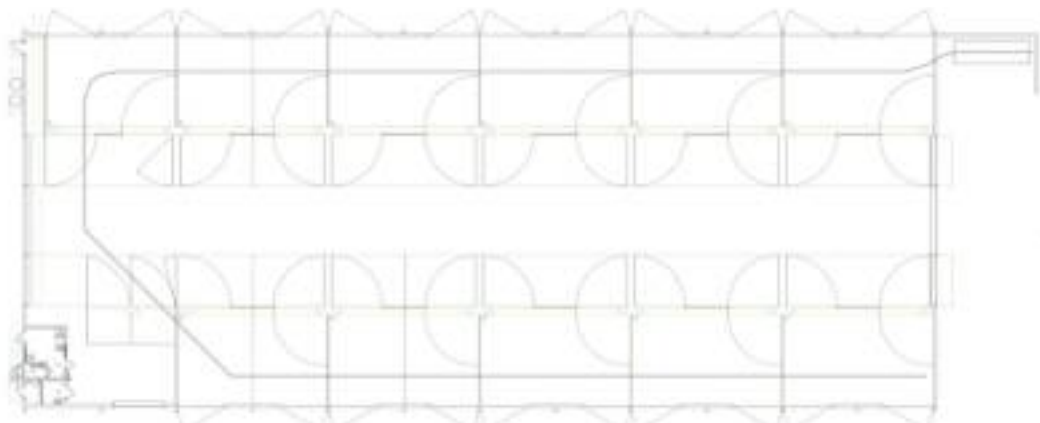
Bild på stallets planlösning (se detaljerad ritning i Bilaga Ritningar).
